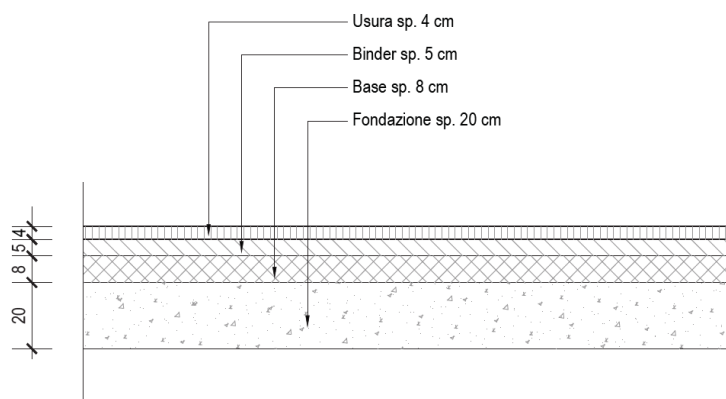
Dettaglio pacchetto di pavimentazione NV04
